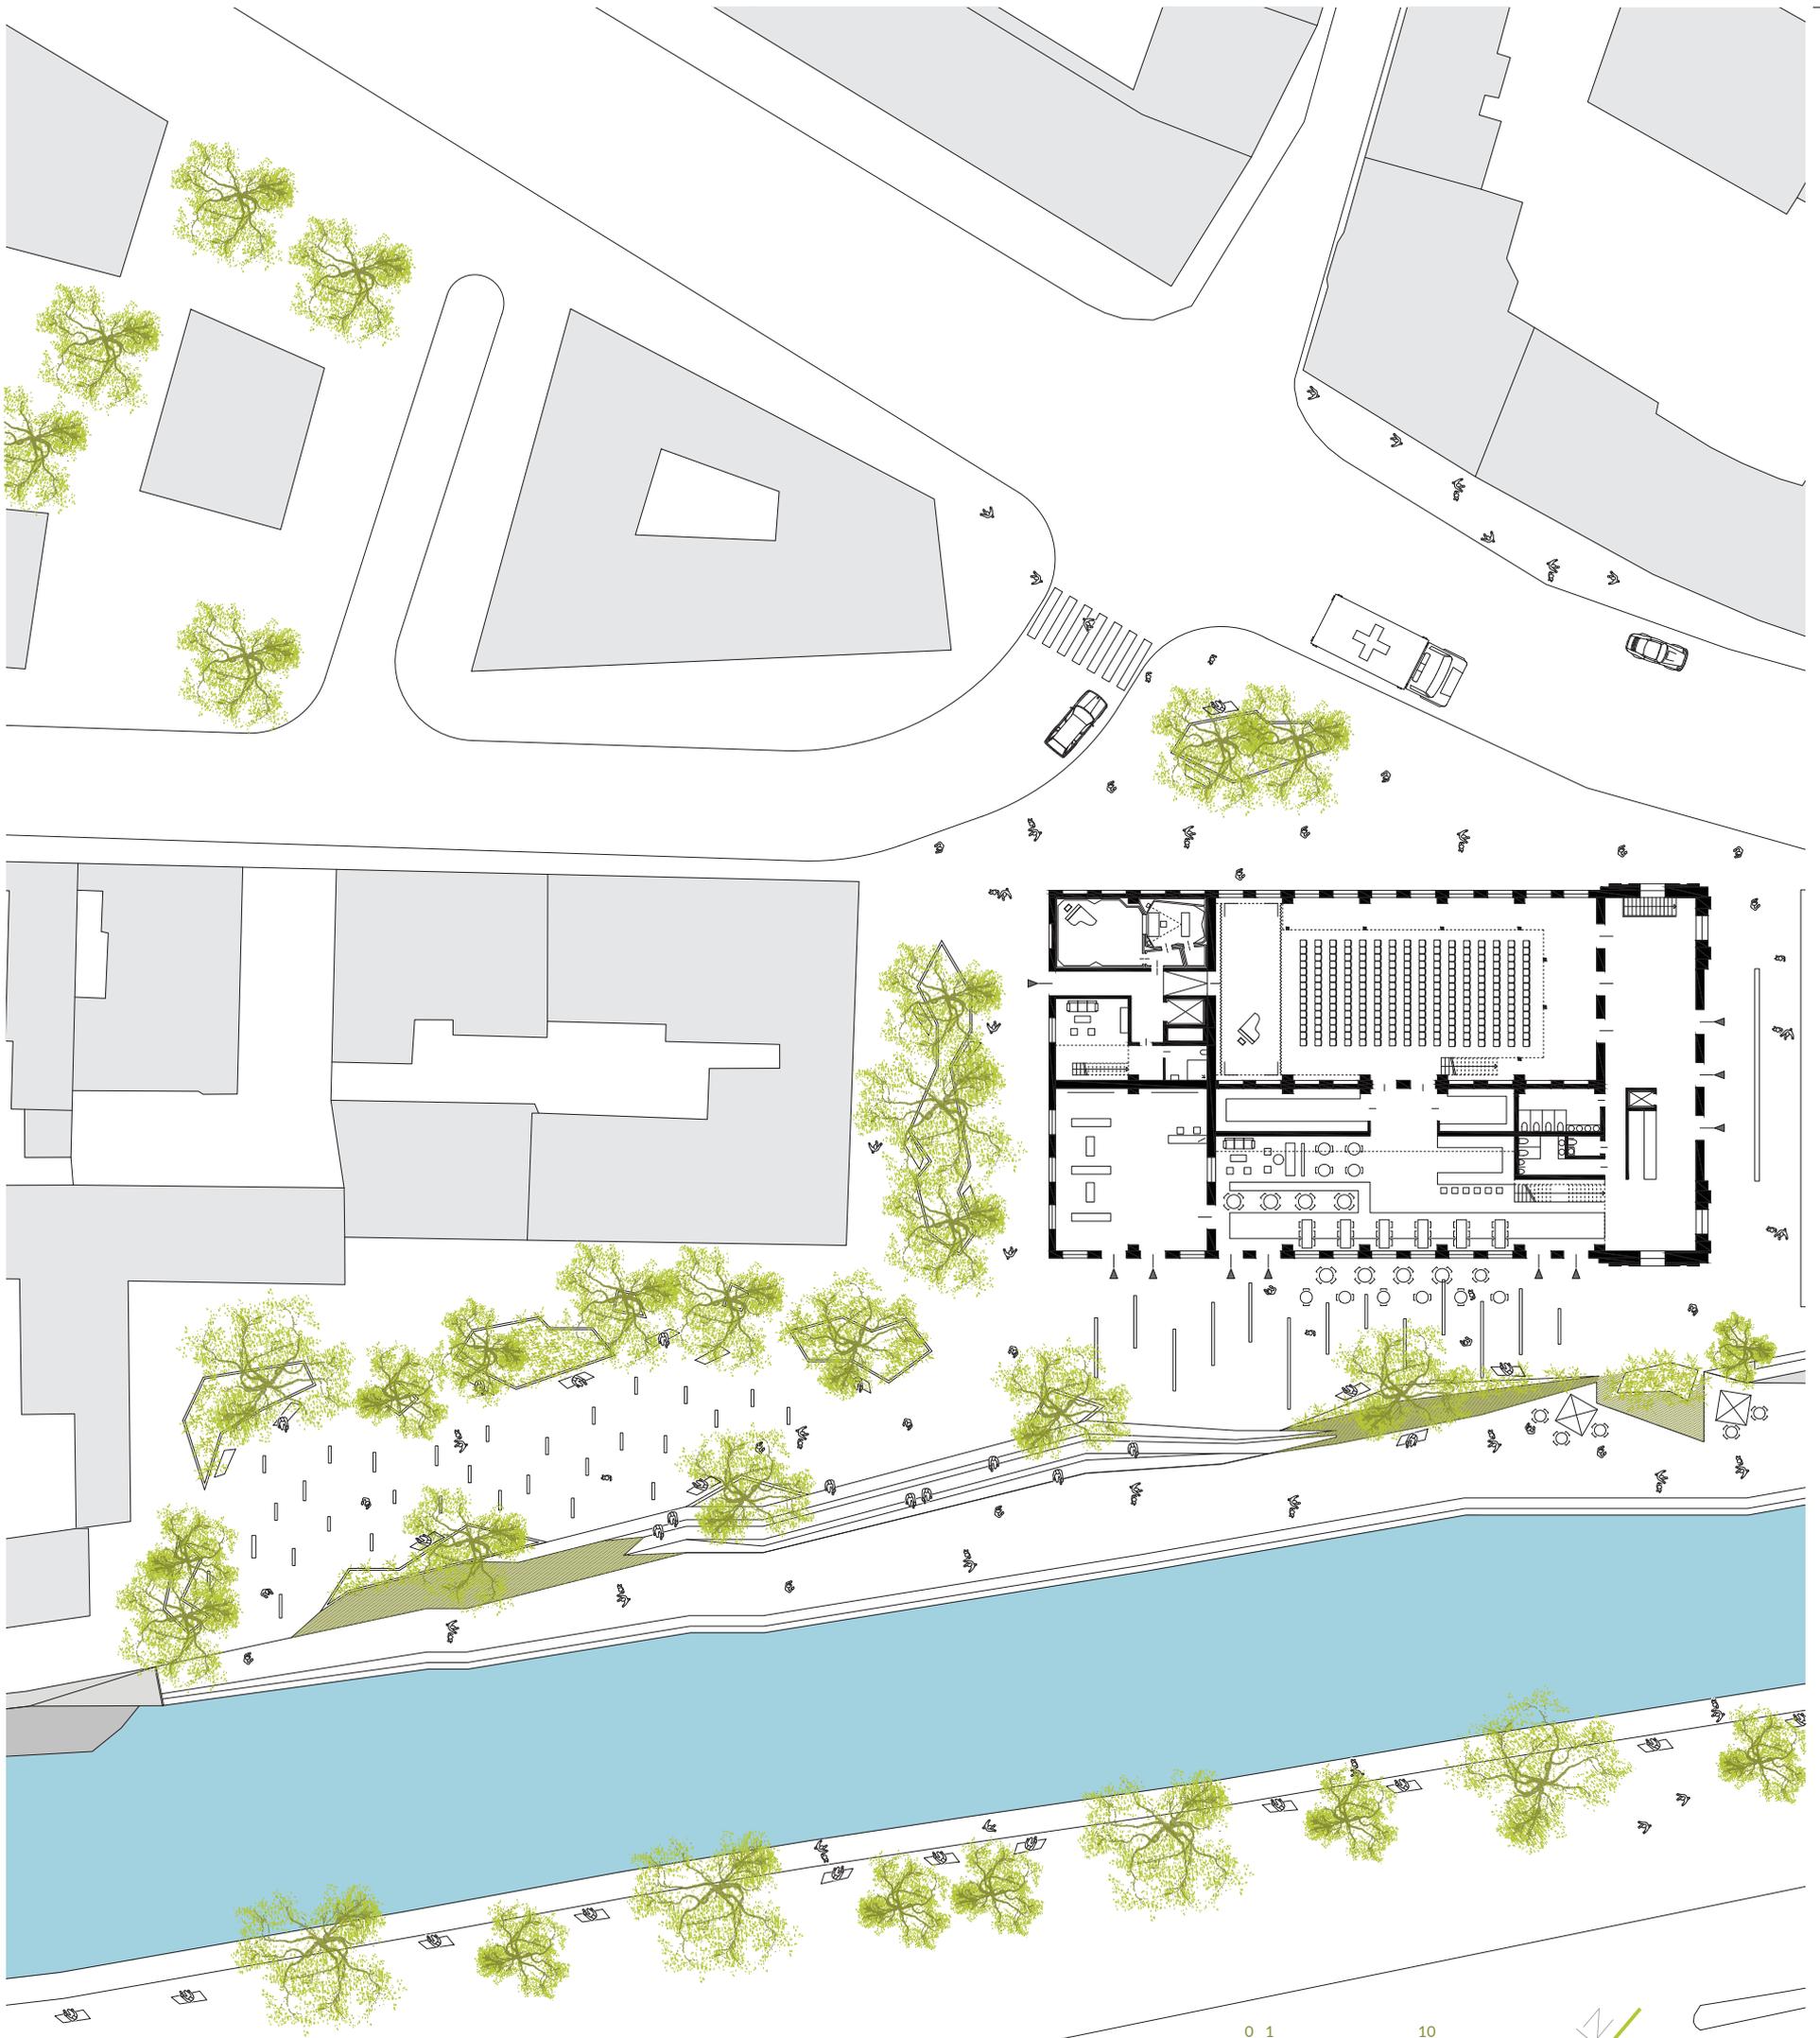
Erdgeschoss- und Außenanlagenplan M 1:500
